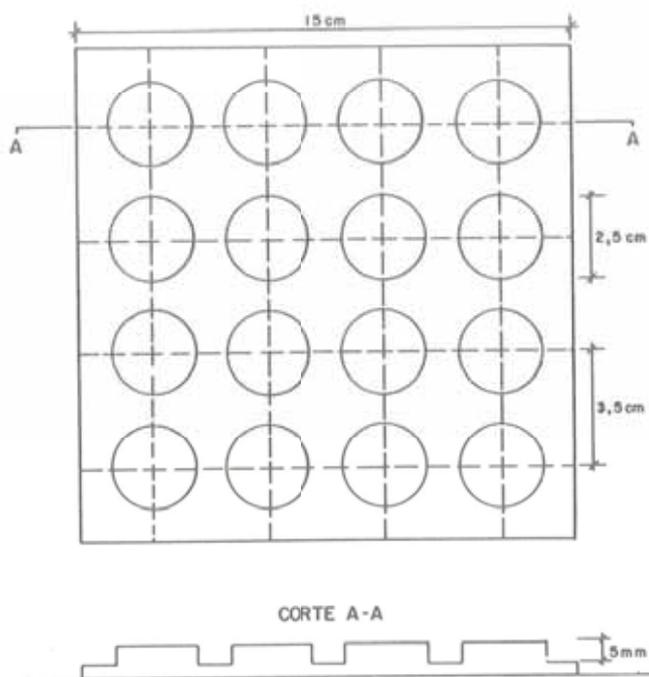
TIPO DE PISO BRAILE UTILIZADO NAS RAMPAS
